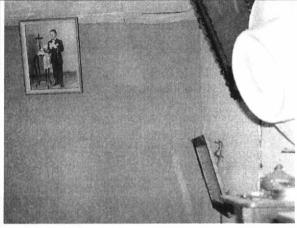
No se identifican daños estructurales en los muros de carga al interior del inmueble.
